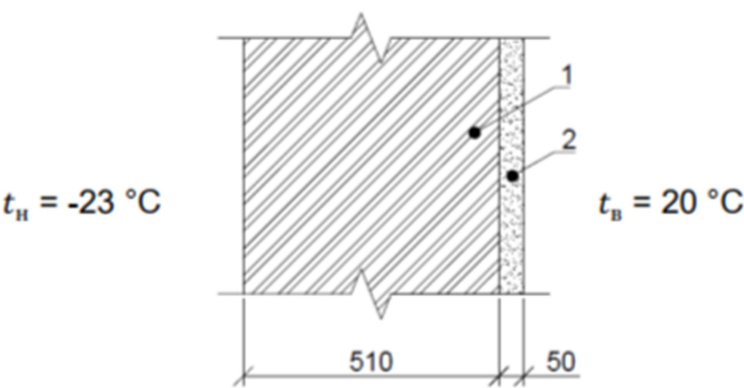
Схема конструкции наружной стены толщиной 510 мм
